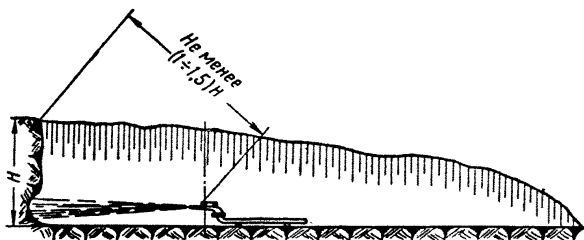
Схема установки гидромонитора в забое на уровне основной площадки выемки
